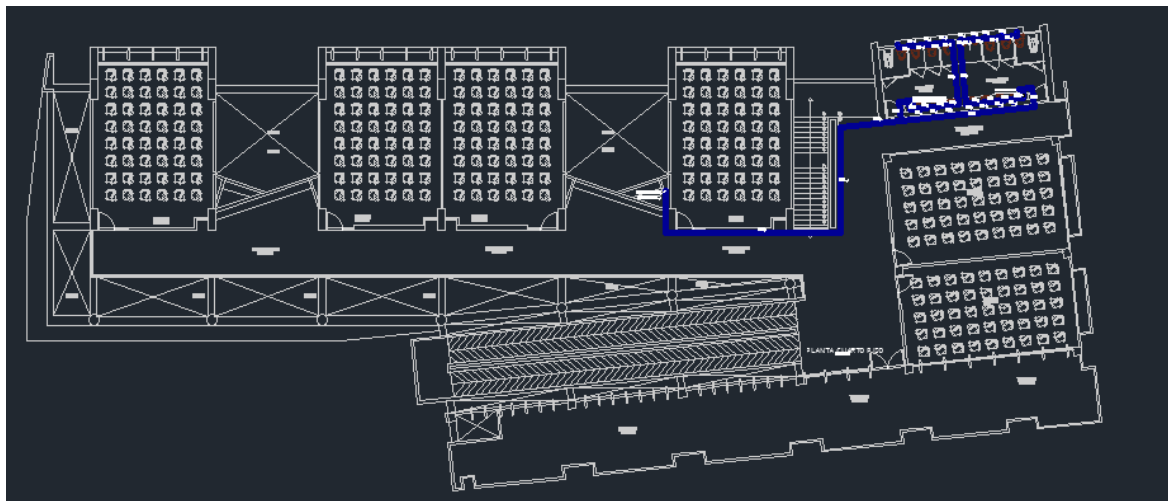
AutoCAD 2D Planta N°4 del edificio aulas oriente.
